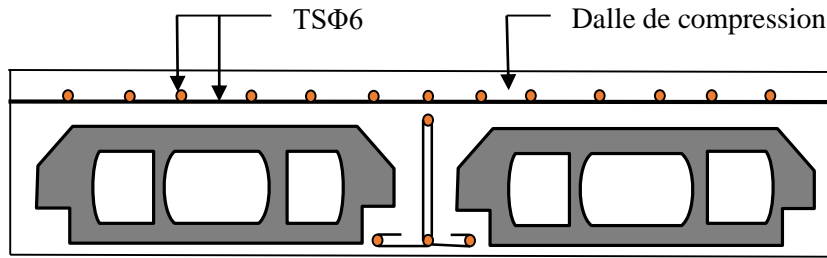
Schéma de ferrailage de la dalle de compression.
